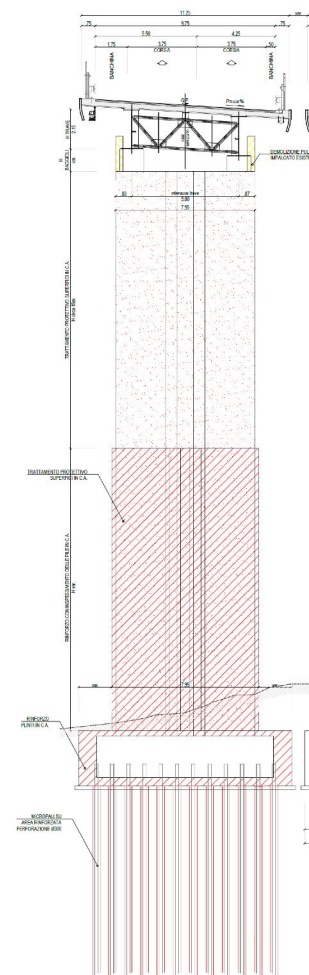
Sezione trasversale e interventi di rinforzo impalcati asse principale
